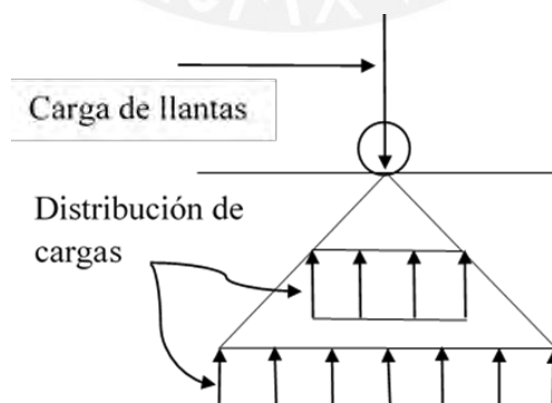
Distribución de cargas en un pavimento flexible (Jain, 2016)
